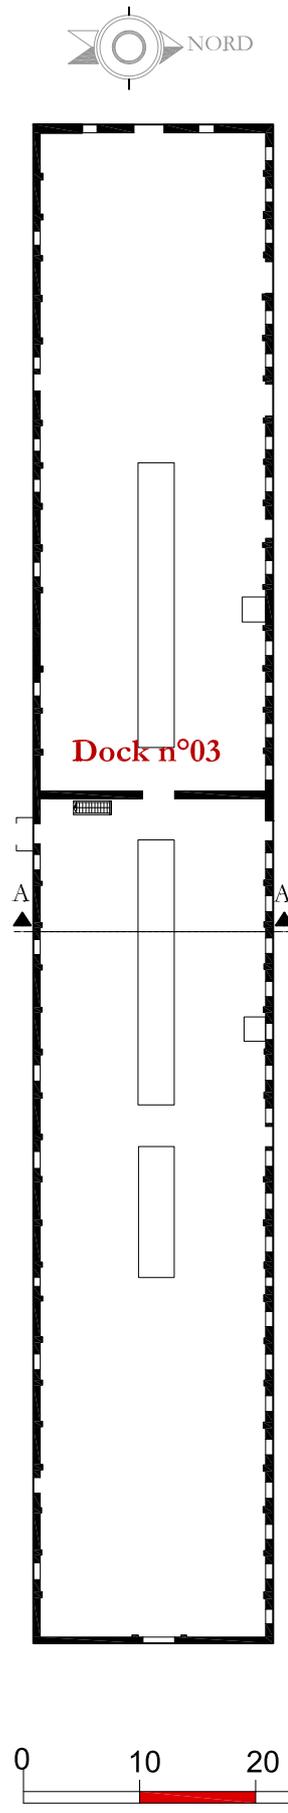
Usine TABACOOP- Bâtiment 1- Dock 3-ve sur les escaliers - rez-de-chaussée- état actuel. Source: Auteur.
